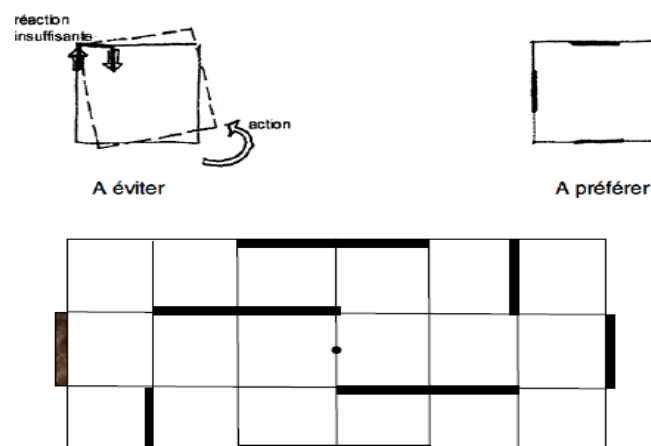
Disposition des éléments de contreventement par rapport au centre de gravité des niveaux [13].
